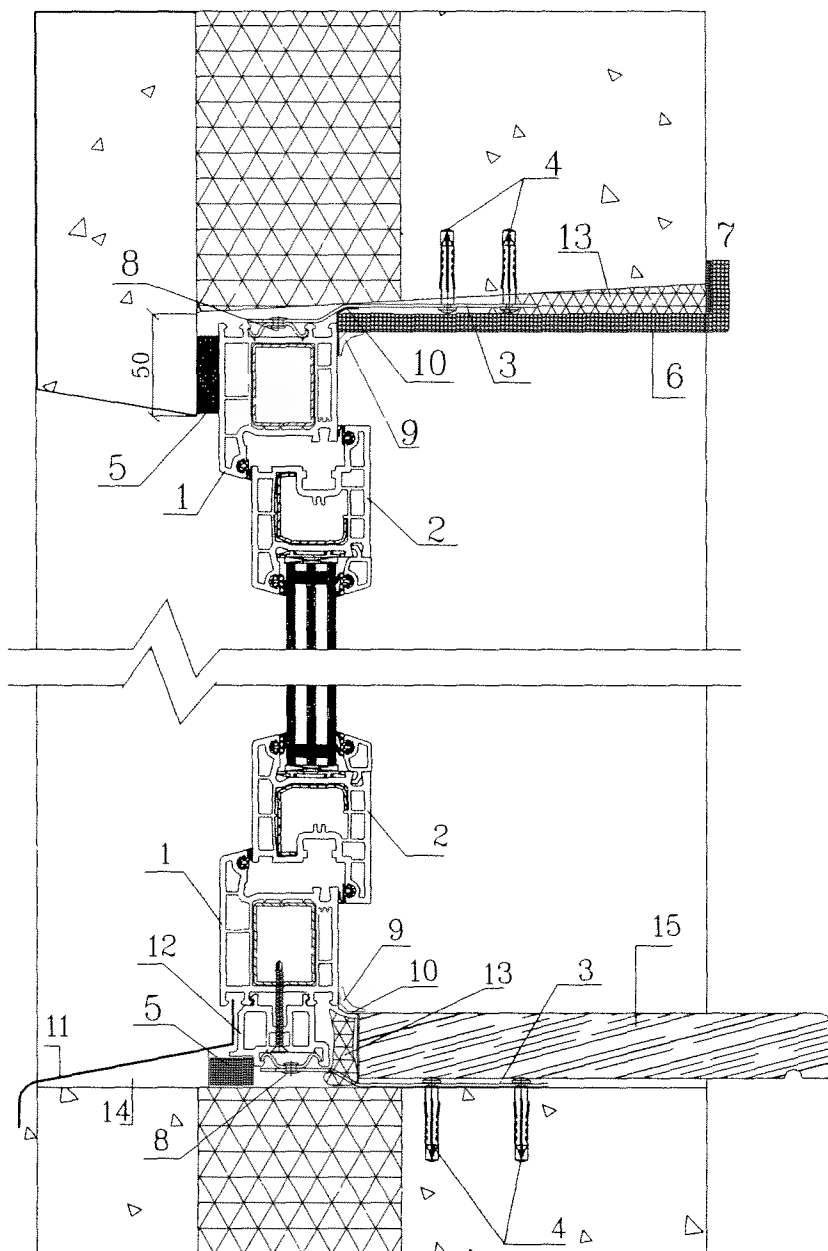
Установка окна из ПВХ в стене из трехслойных железобетонных панелей.
